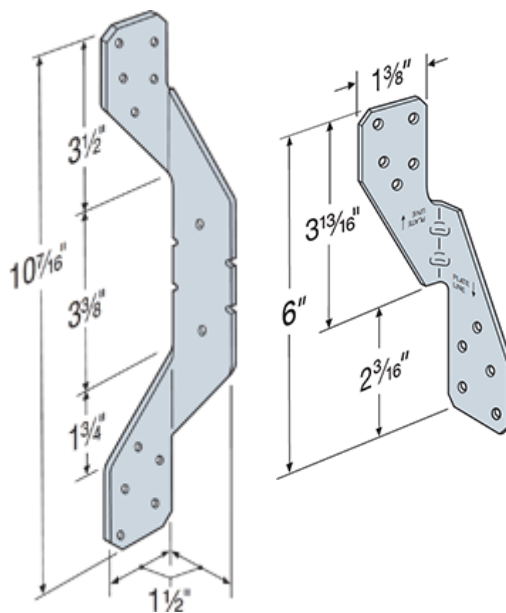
Ejemplos de modelos para riendas metálicas de anclaje de la estructura del techo al entramado de la pared (las dimensiones de los ejemplos son sólo ilustrativas).
